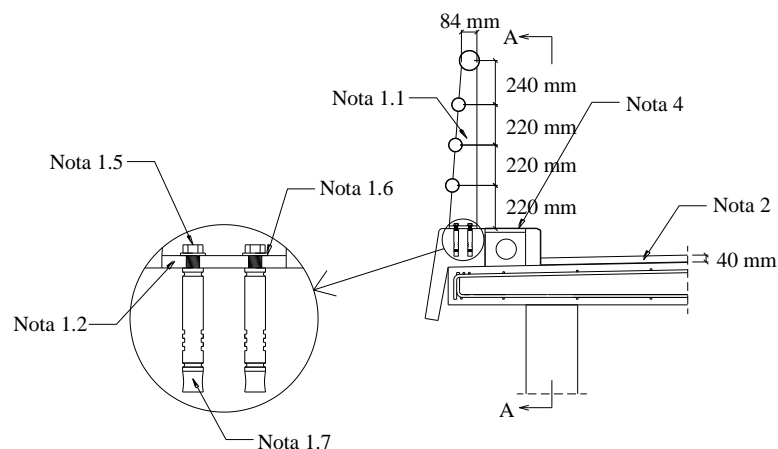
Secção transversal dos guarda-corpos e juntas de dilatação.
